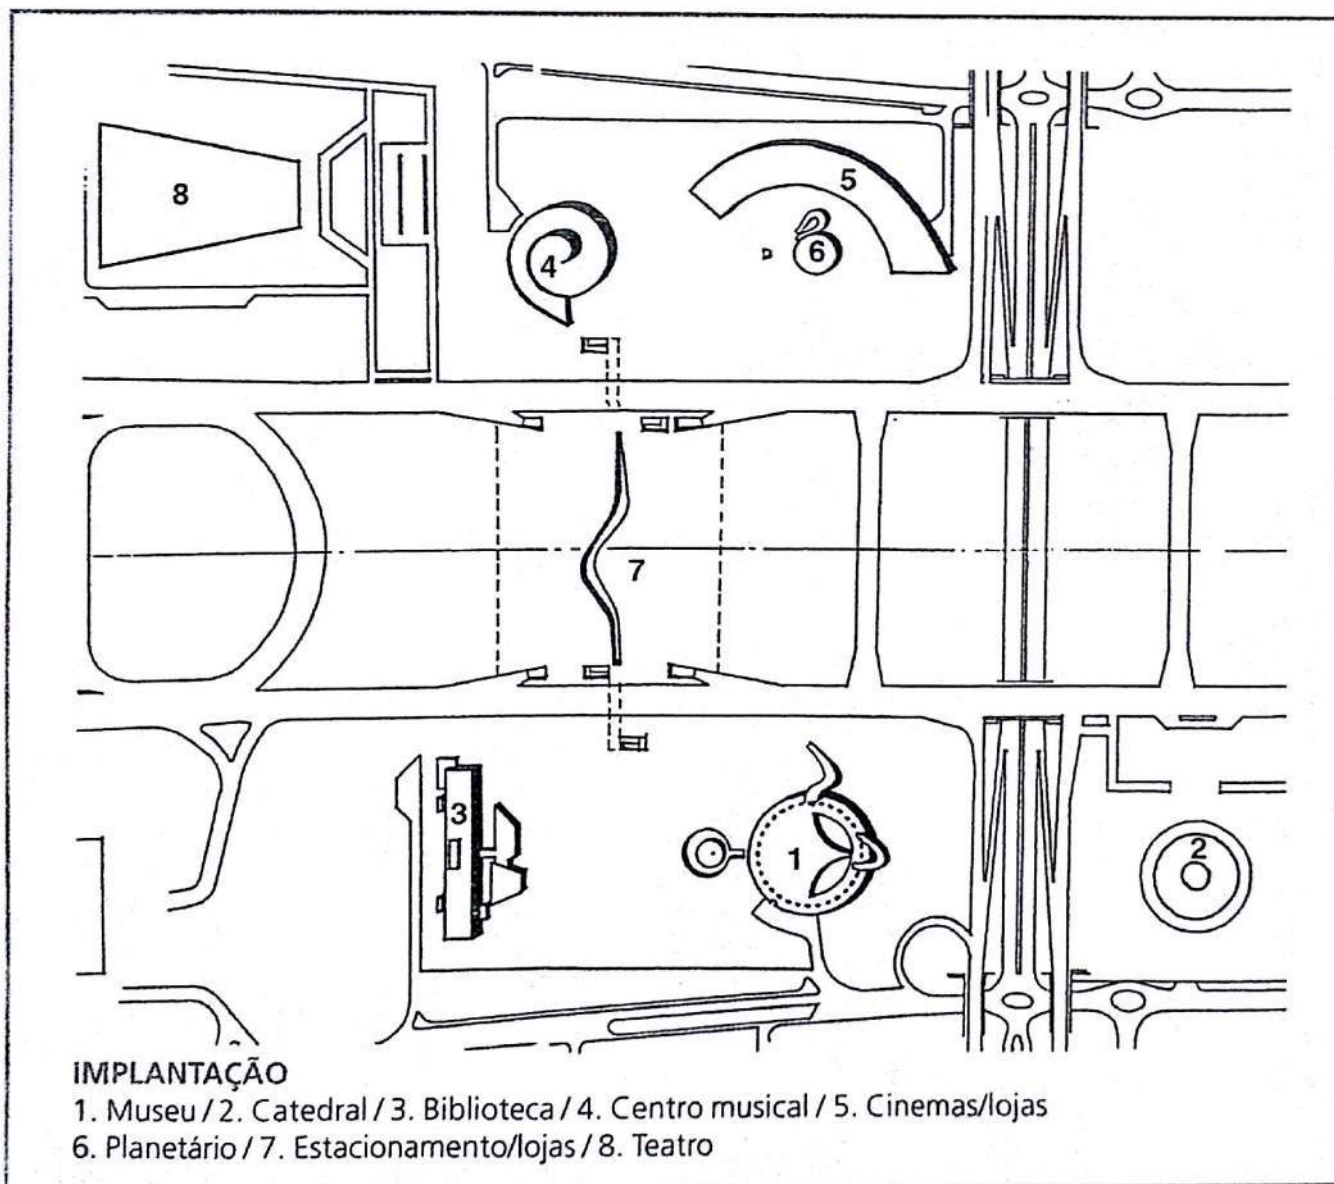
Planta de Implantação, 1999. Fonte: Revista Projeto, 2001.
